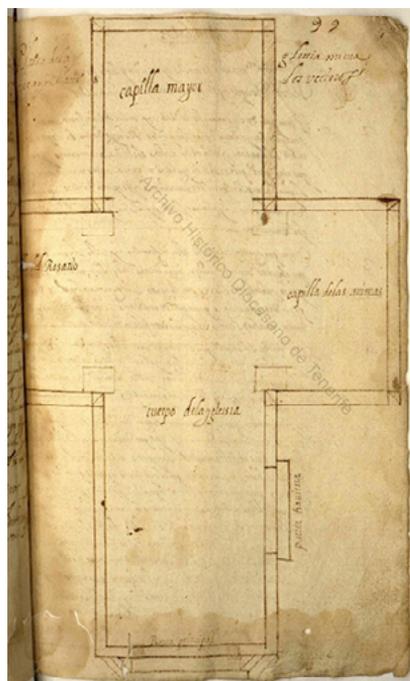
Proyecto de nueva planta para el templo parroquial de San Juan Bautista, Vallehermoso (1632) AHDSCLL, fondo parroquial de dicha parroquia. Foto: AHDSCLL.
